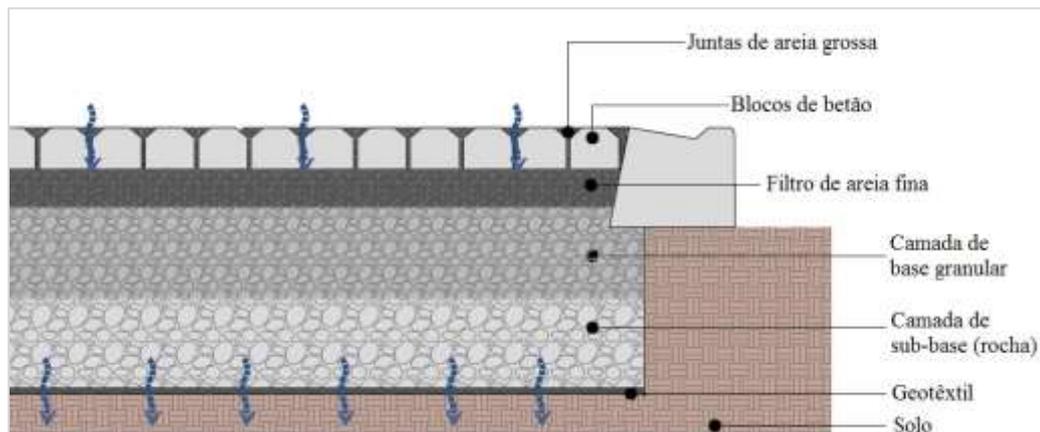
Estrutura de um pavimento intertravado de blocos de betão
